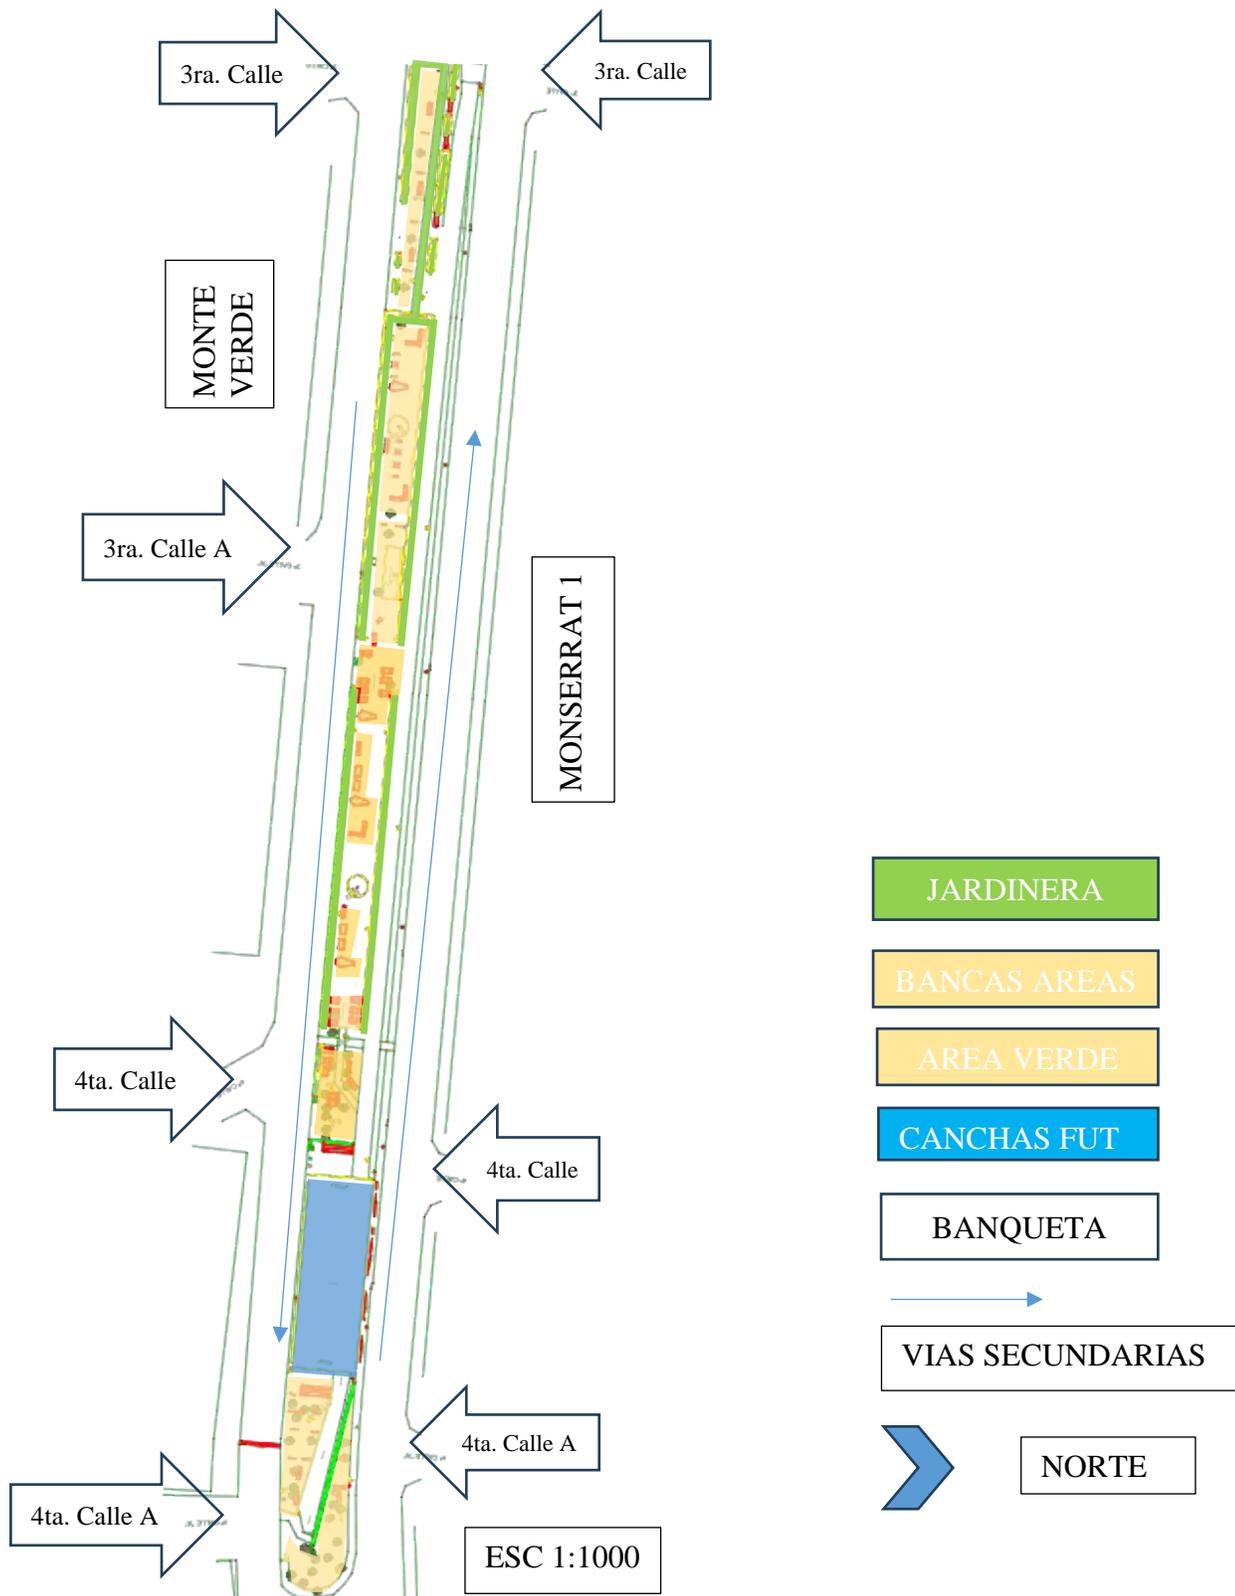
Sector 2 Existente entre la 3.ª calle a 4.ª calle A, zona 4 de Mixco
